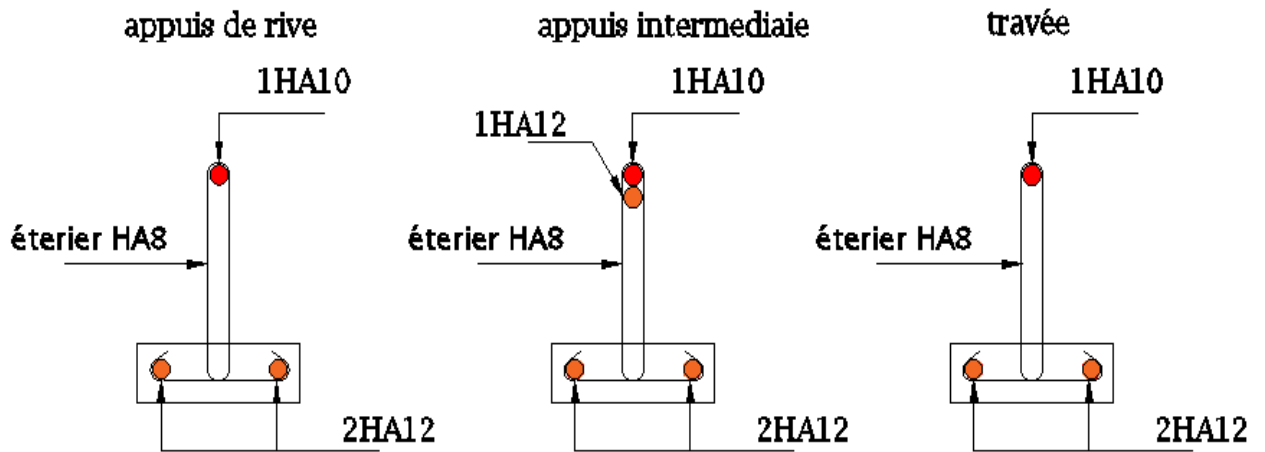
Ferrailage des poutrelles de RDC-bas.
